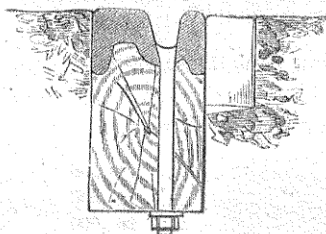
Tramways de Constantinople. Section du rail, etc. 23 kil. par mètre courant. Échelle 1/6.
